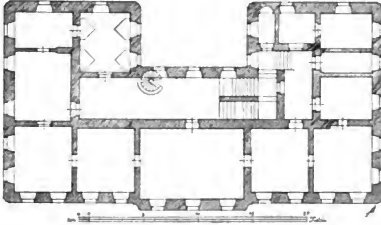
Buková. Grundriss des Schlosses.
